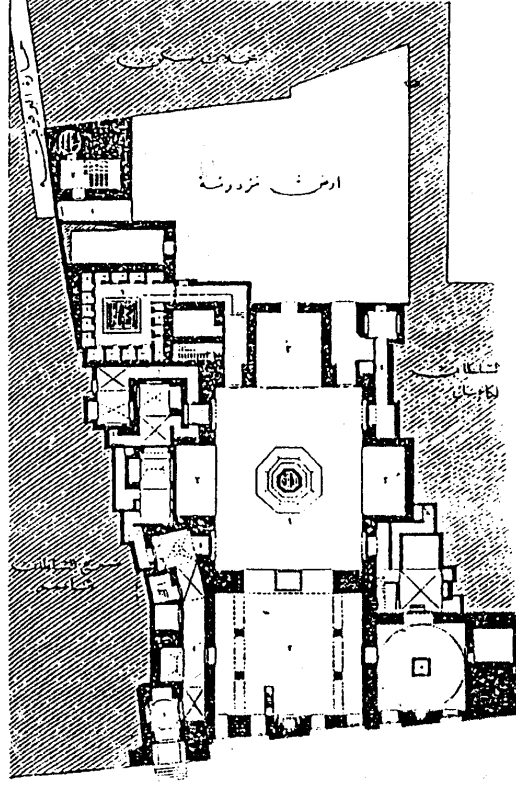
مسقط أفقي لجامع أصلم السلحدار بالقاهرة (عن : المجلس الأعلى للأثار) .
